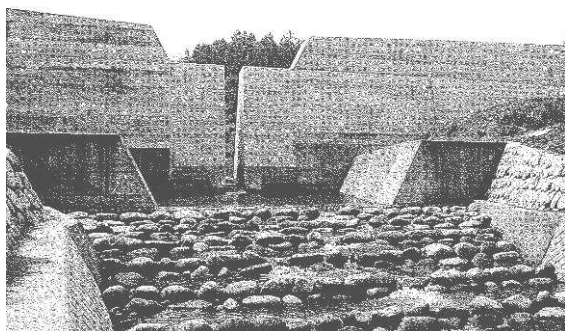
(c) コンクリートスリット式砂防えん堤
